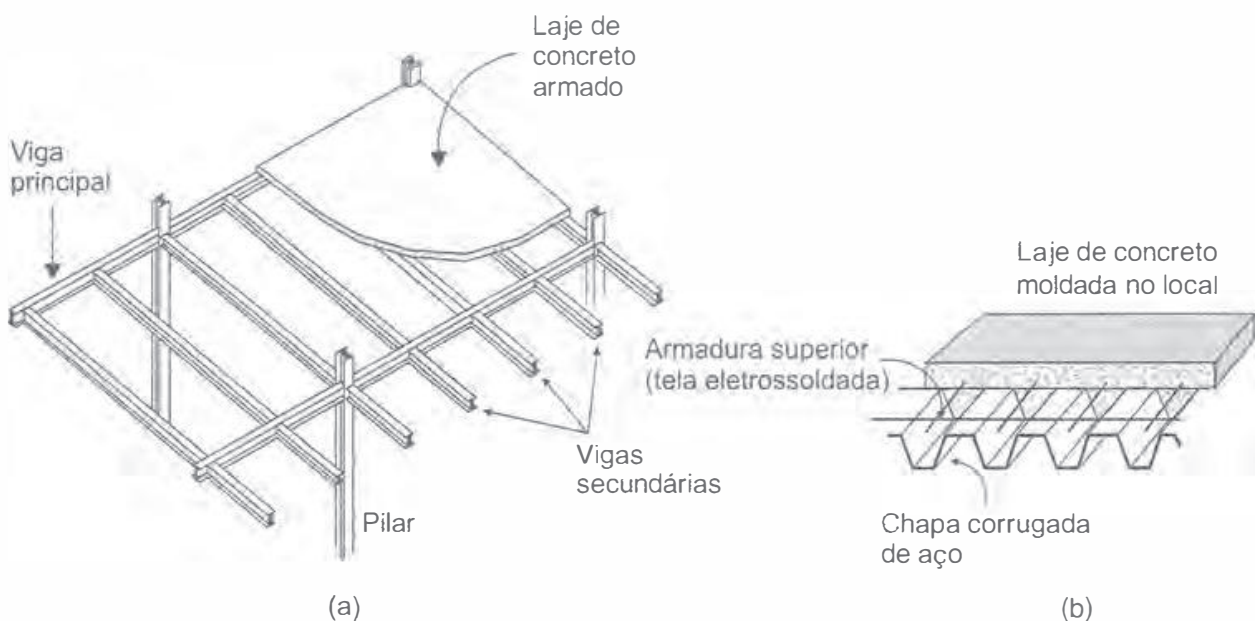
Sistemas de piso em edificações. (a) Vigas principais e vigas secundárias. (b) Laje tipo *steel deck*.
